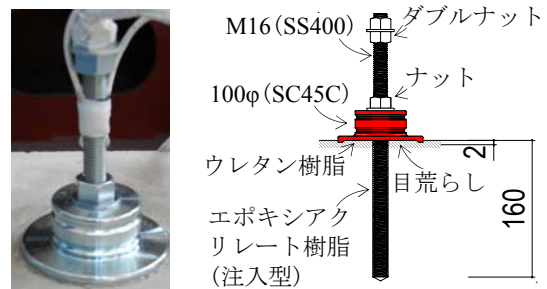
ディスク型アンカー 図-3 詳細図 (単位:mm)
